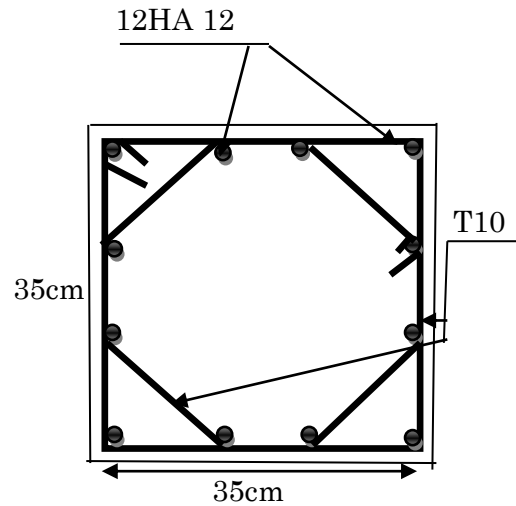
Ferrailage des poteaux Poteaux 4^{ème} et 5^{ème} étages
